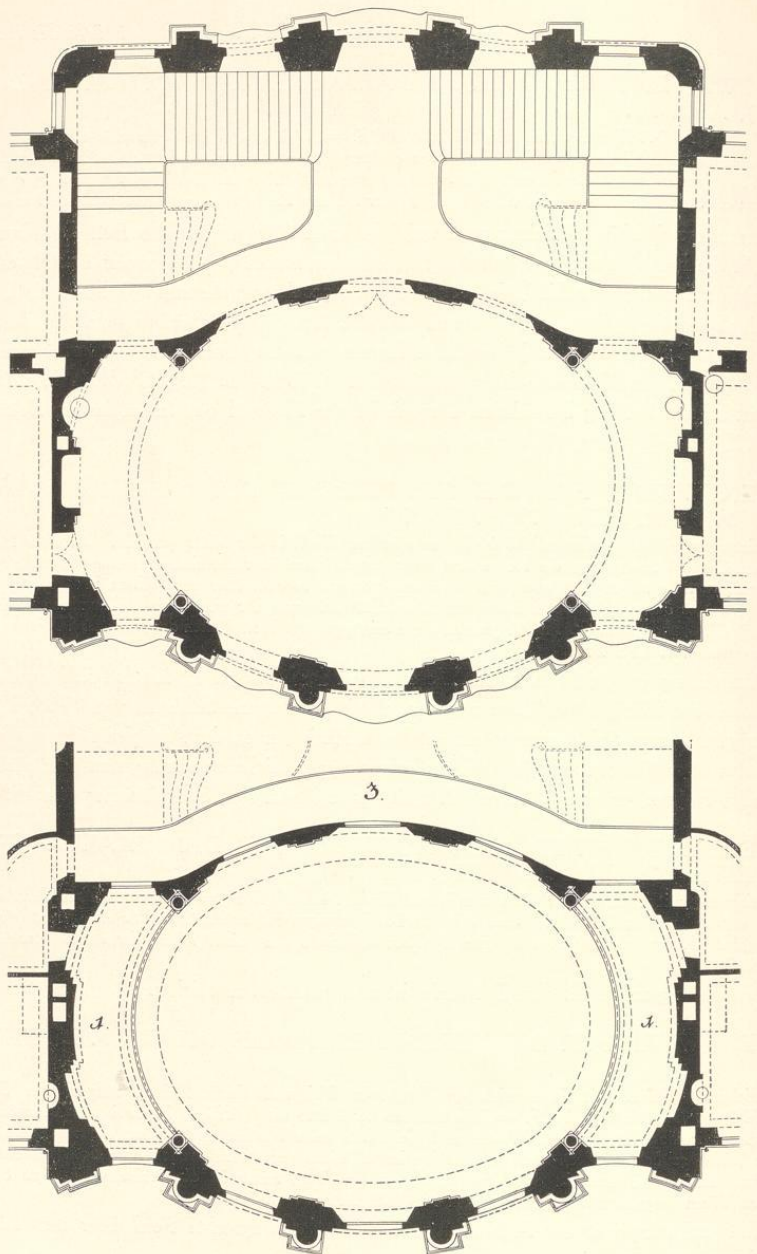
Grundriß des Saales und Treppenhauses im Hauptgeschoß nach dem Entwurfe Schlauns
